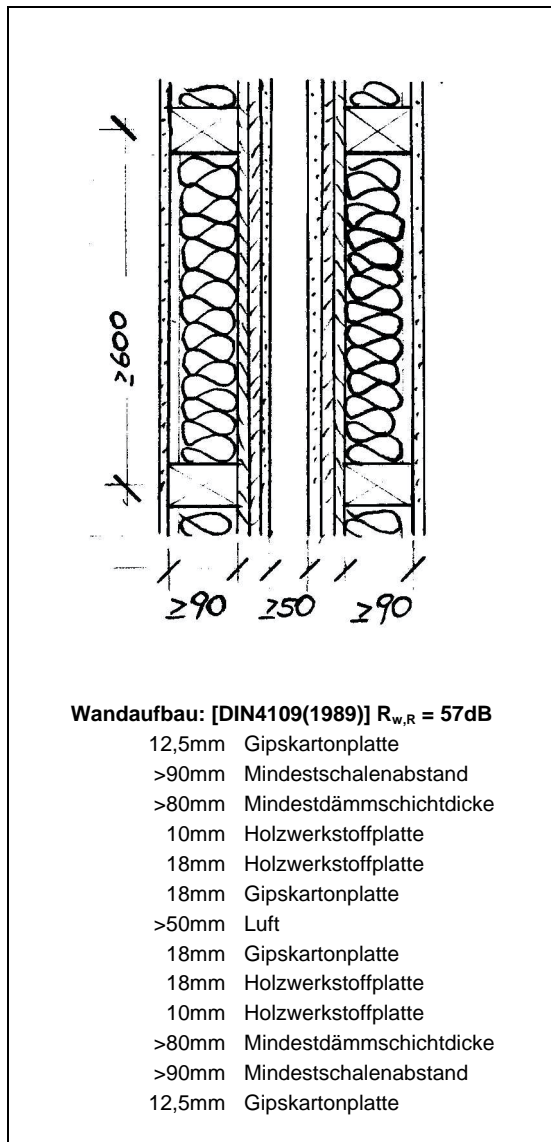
Wandaufbau nach DIN 4109 (1989)
